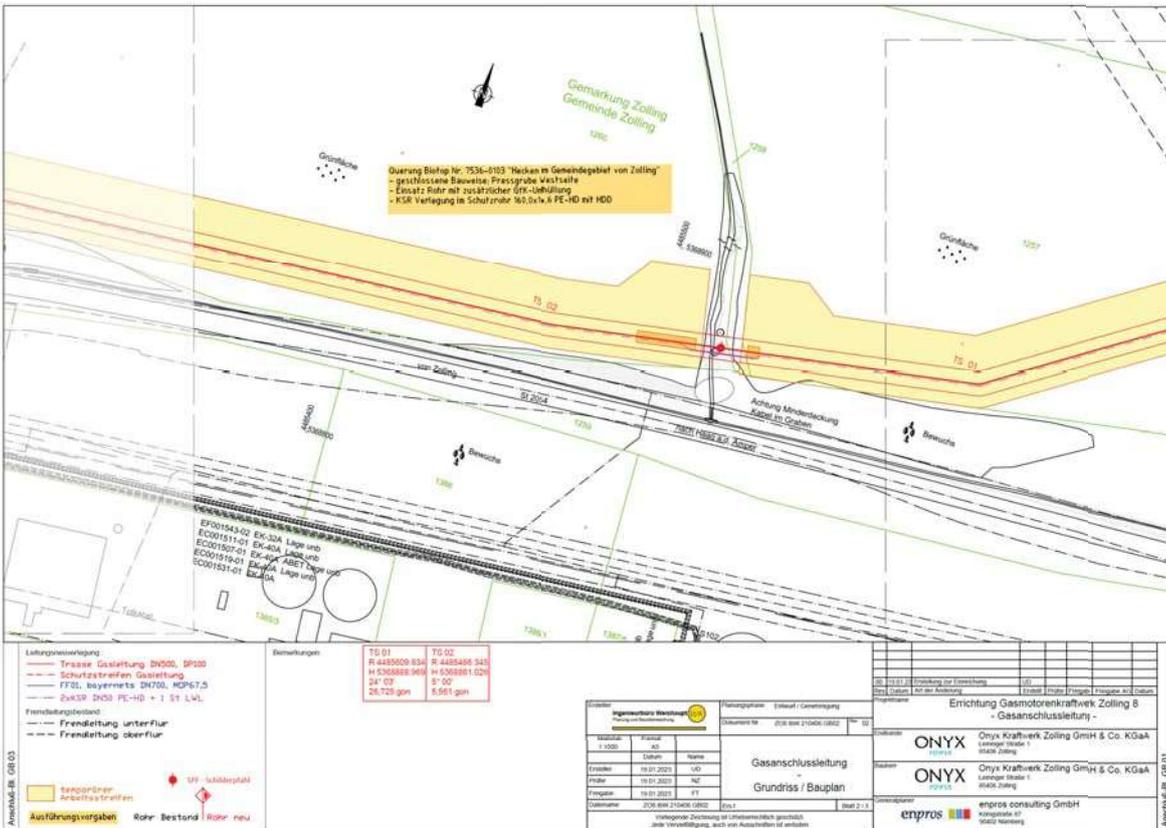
Gasanschlussleitung – Grundrissbauplan Teil 2 [IBW 2023]
